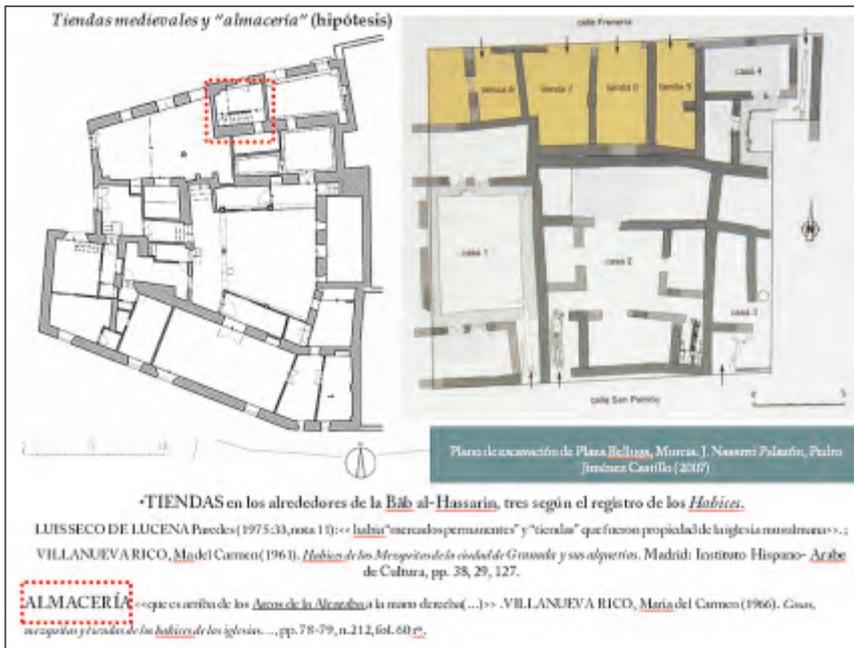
C3, Cuesta de las Arremangadas, 6. Planta baja del estado previo a la última reforma (2002-2007, A. Navarro Suárez) y planta baja de la excavación en la Plaza Belluga, Murcia.
